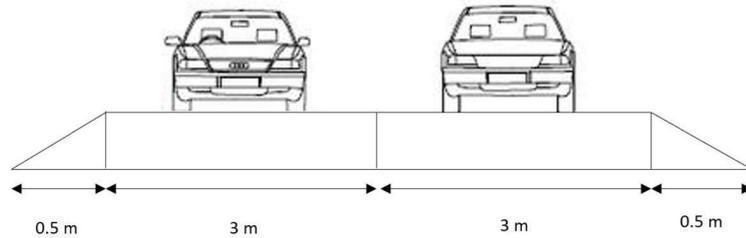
Sección transversal nueva. Fuente: Elaboración propia.
